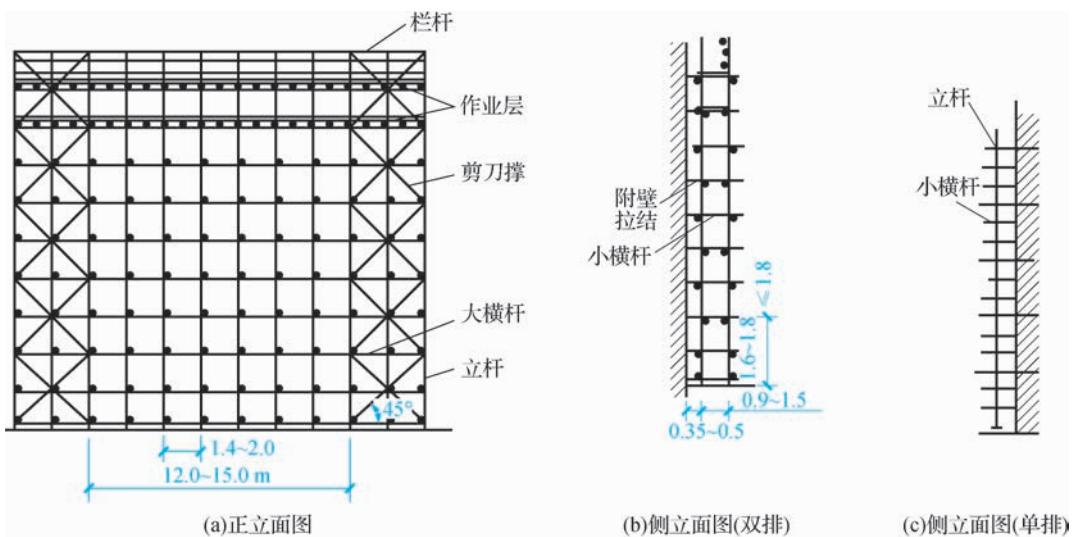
扣件式钢管脚手架构造形式(单位:m)
